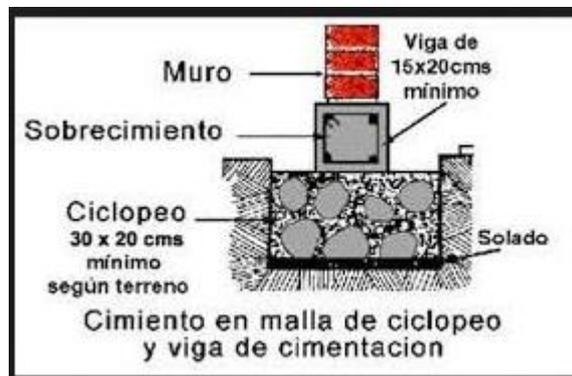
muro perimetral con cimiento, sobrecimiento.
